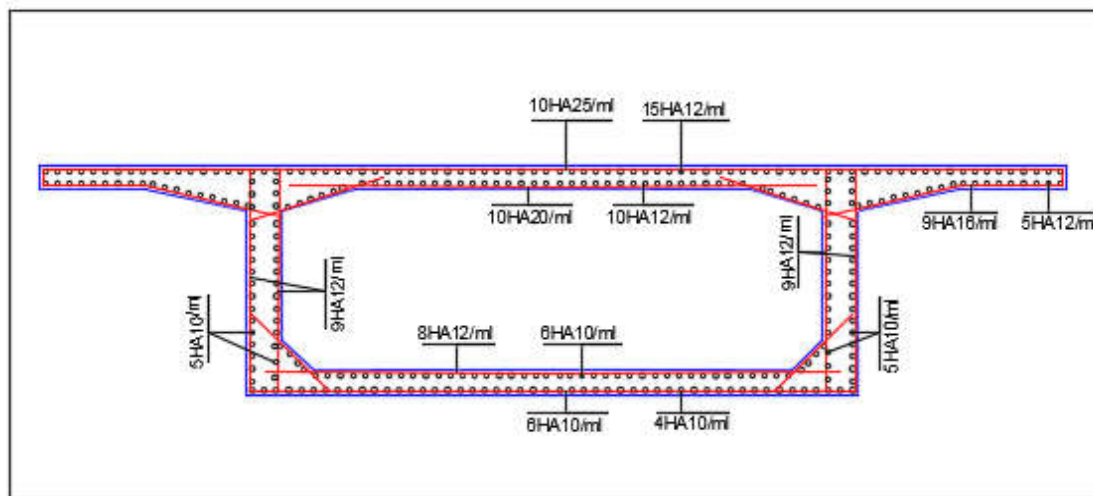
Schéma de ferrailage du voussoir de clavage
